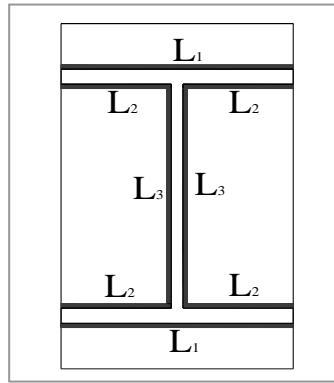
Assemblage soudé poutres –platine.
